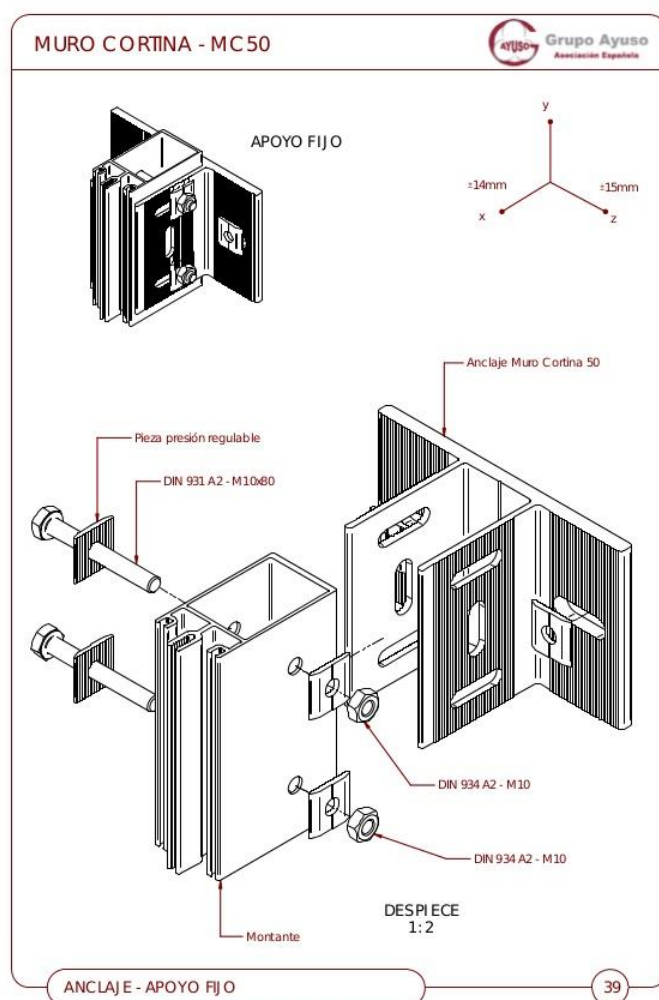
Conjunto anclaje-muro cortina-tornillería
